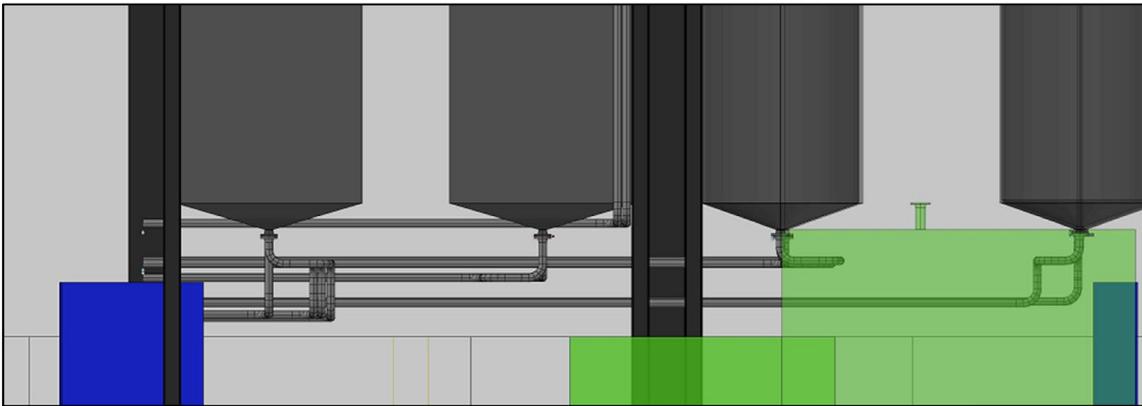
Vista lateral da zona de enchimento com a implementação proposta da tubagem.
